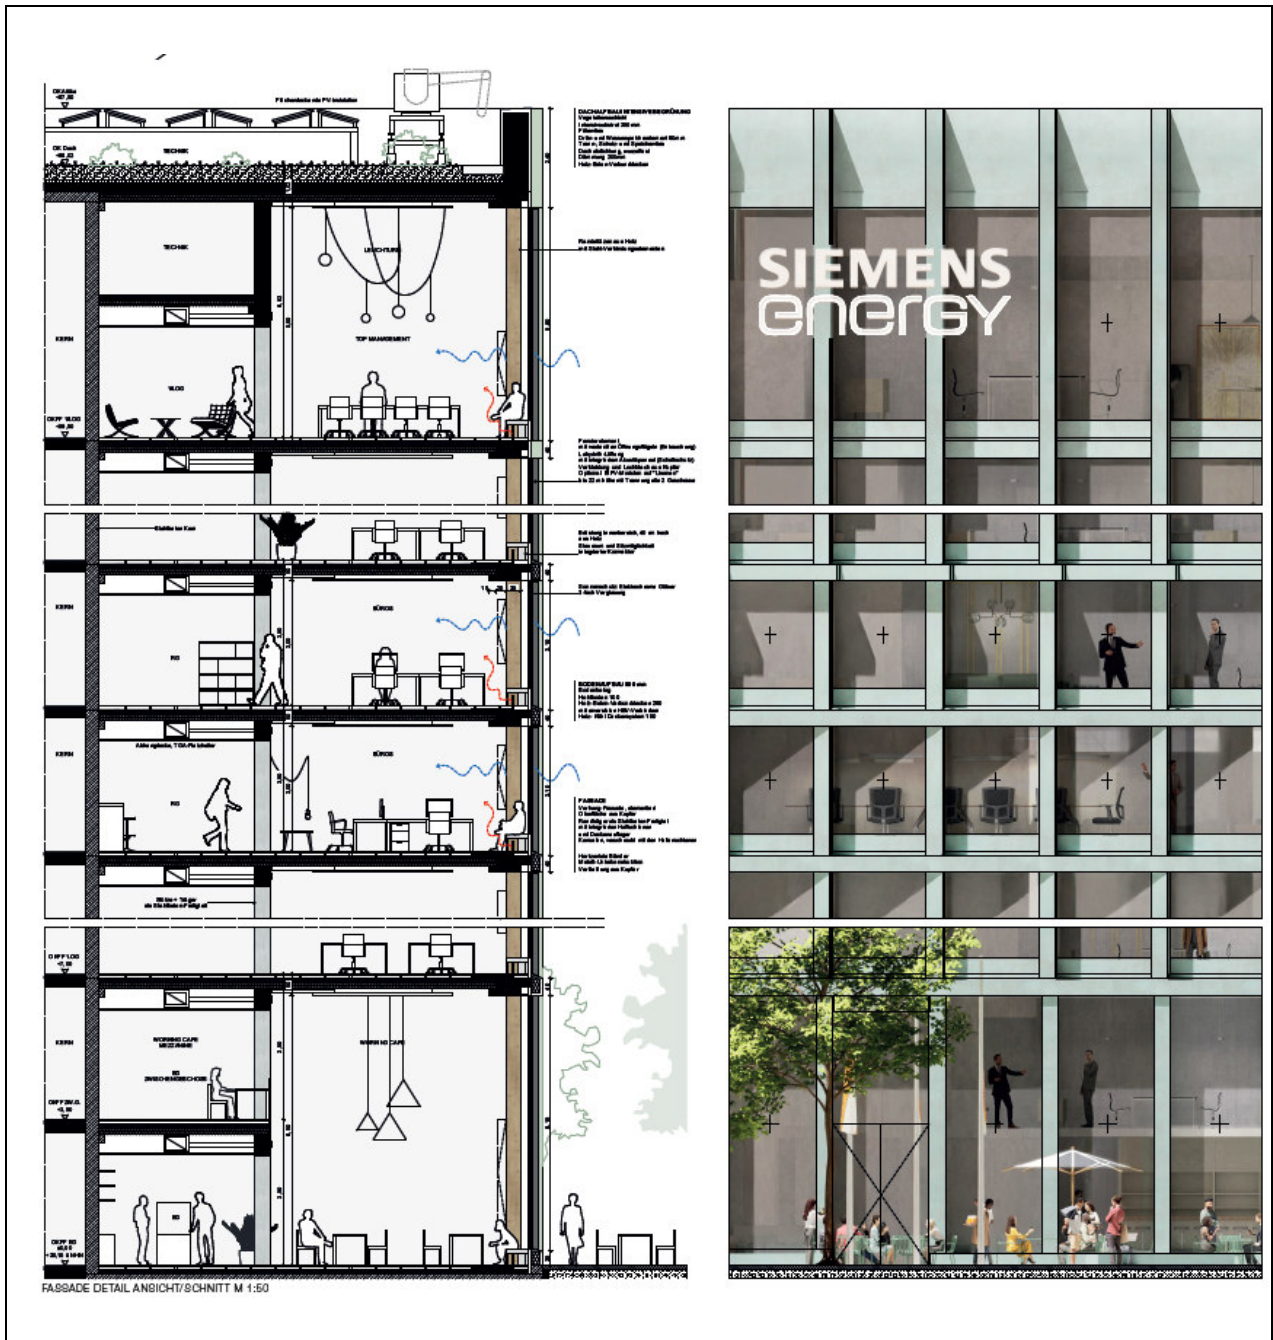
Bauvorhaben Turm; Schnitt, Fassadendetails, Dach mit flächendeckender PV-Anlage, Sonnenschutz: Elektrochrome Gläser 3-fach Verglasung, (aus /72/)
